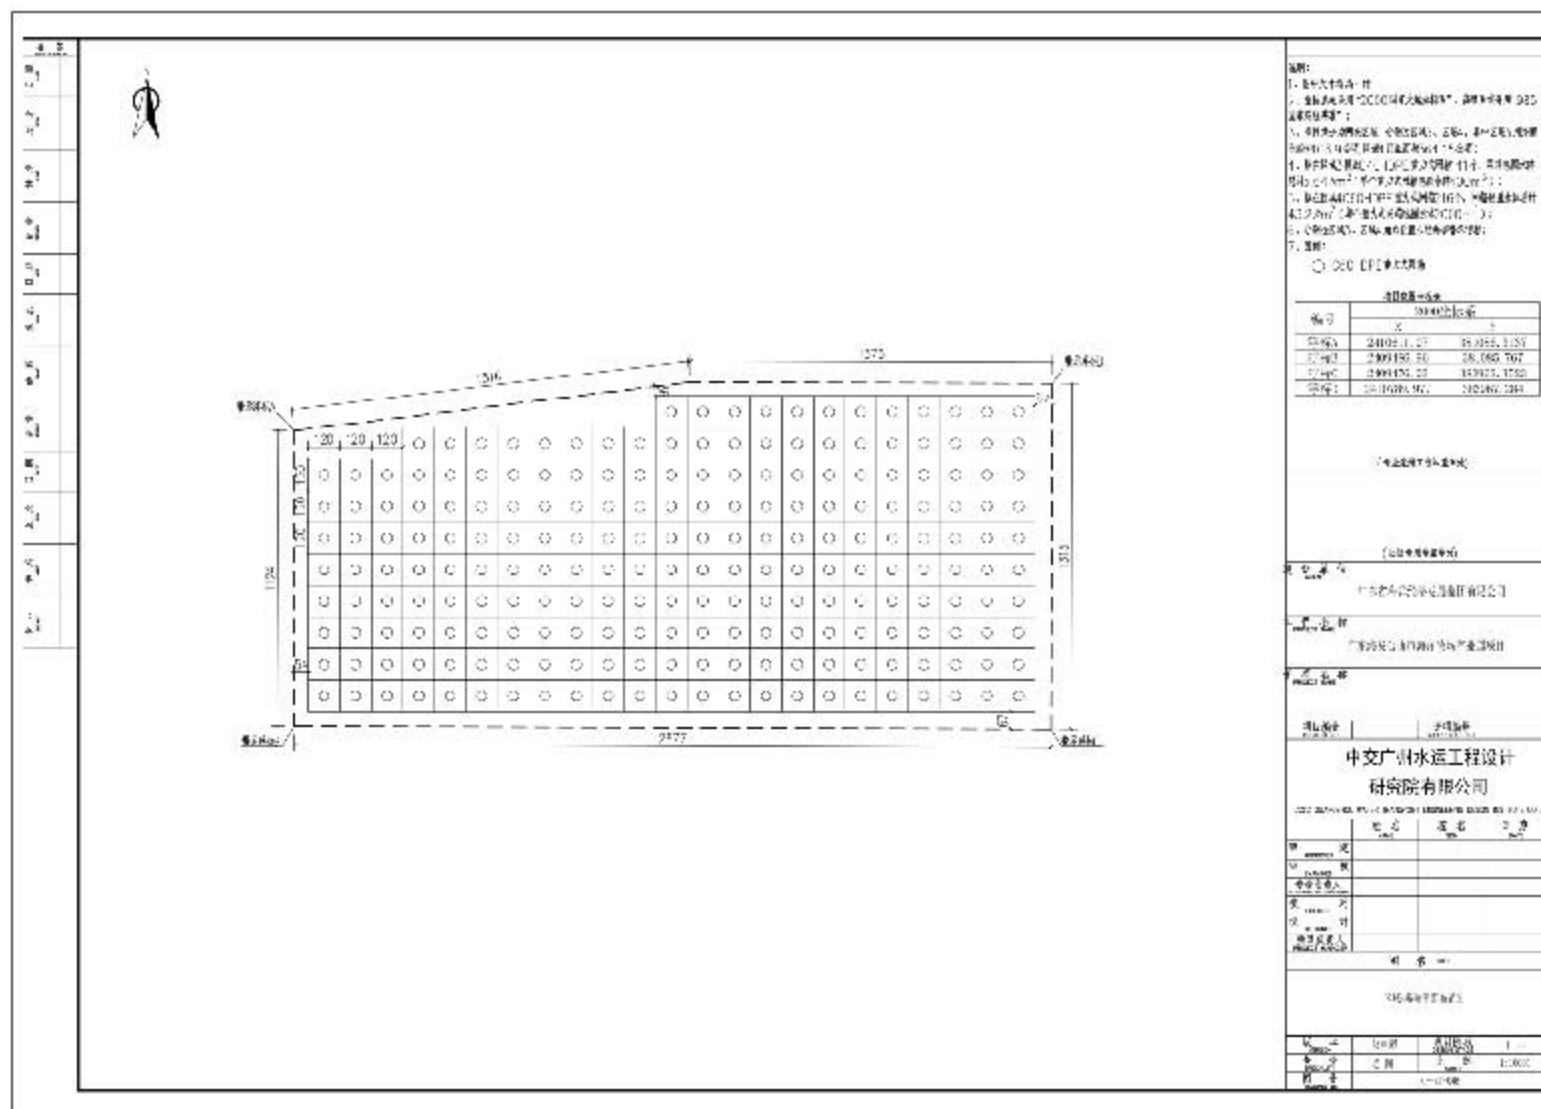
区域 4 平面布置图（网箱养殖）
